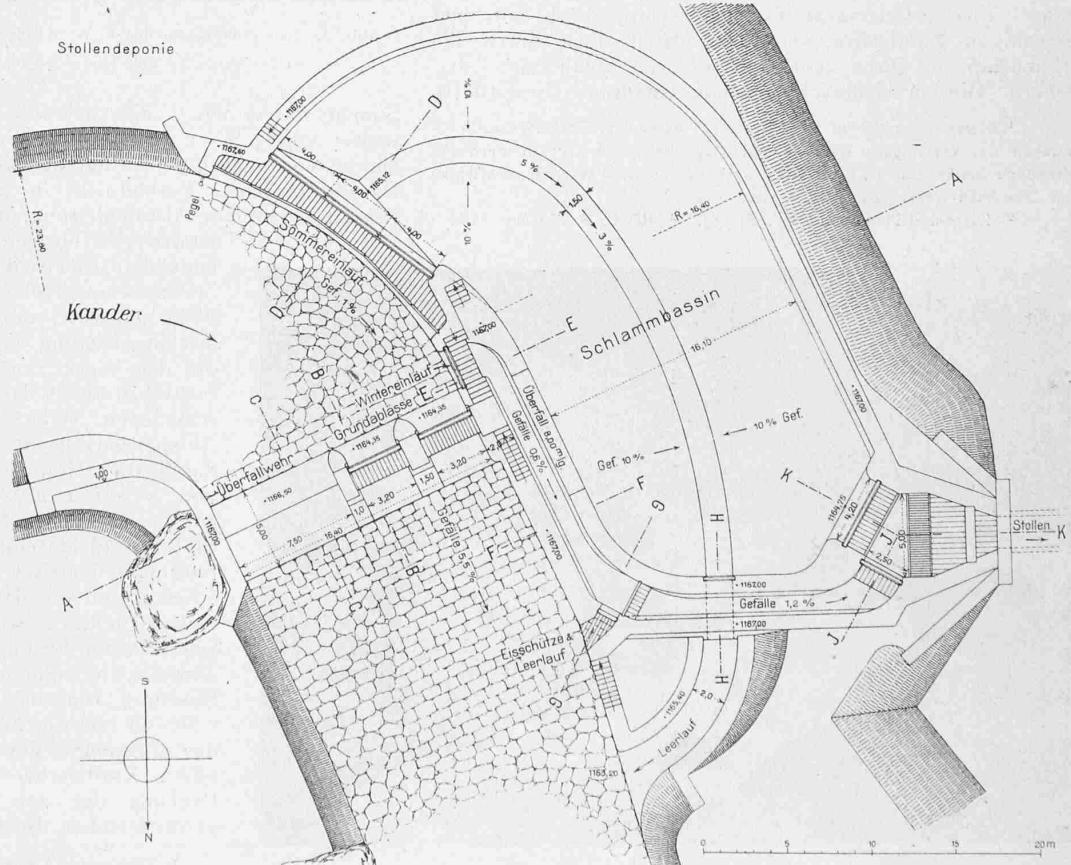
Lageplan der Wehr- und Kläranlage des Elektrizitätswerkes Kandergrund. — 1:400.
